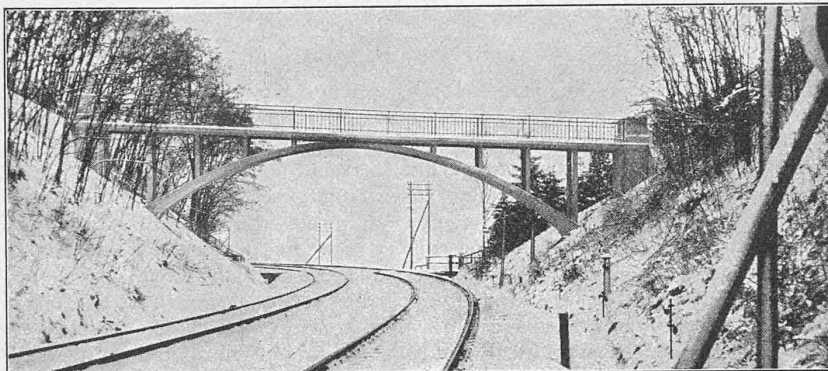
Wegüberführung auf der Strecke Stuttgart-Vaihingen.
